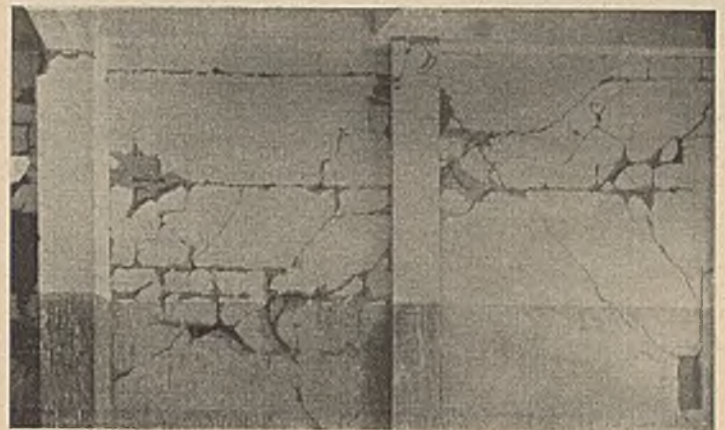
Gebäude der Buick-Agentur: Zertrümmerungs-Erscheinungen an einer Zementsteinwand des Erdgeschosses. — Auch die Stützenköpfe zeigen Ribbildungen.
